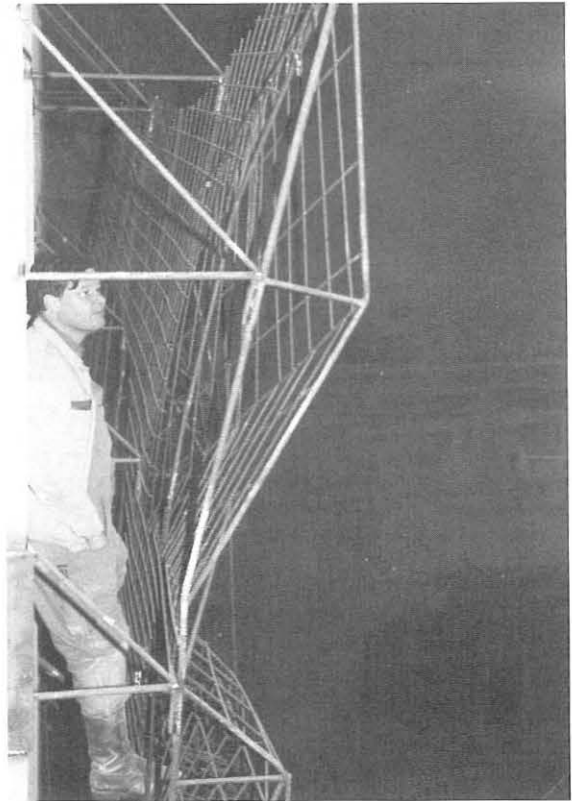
Montage des vorgefertigten Rundeisenskelettes am tragenden Gerüst aus Stahlprofilen
